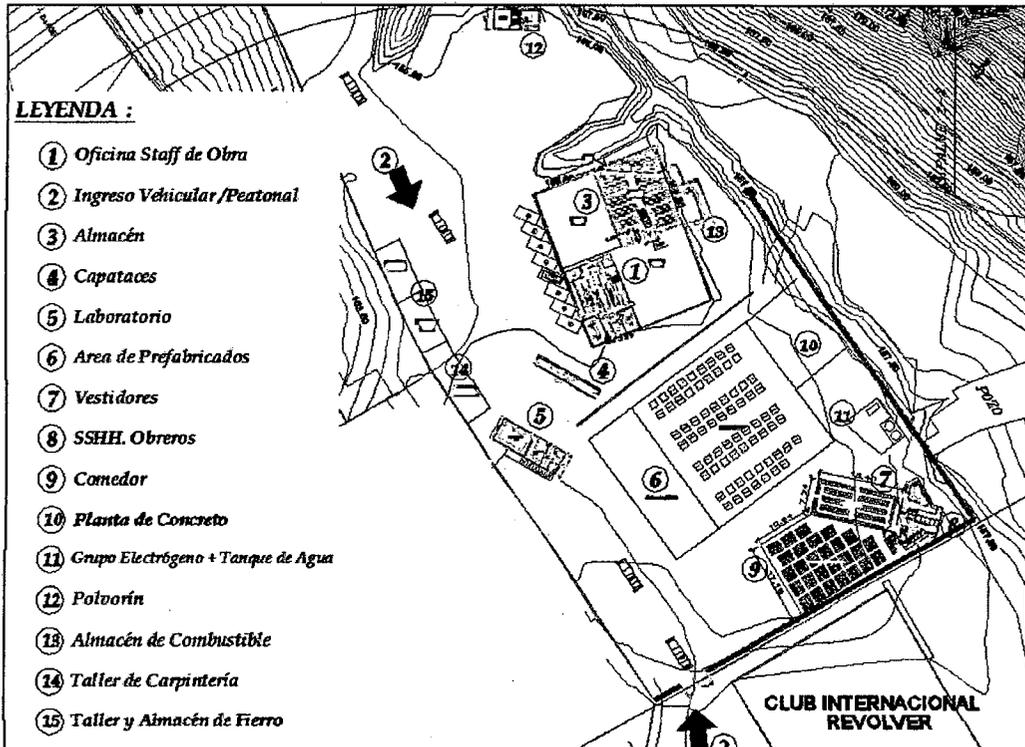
Distribución de obra, para la zona de prefabricados. Ubicación de la planta al pie del cerro Santa Rosa. Fuente: Oficina Técnica de Obra.
